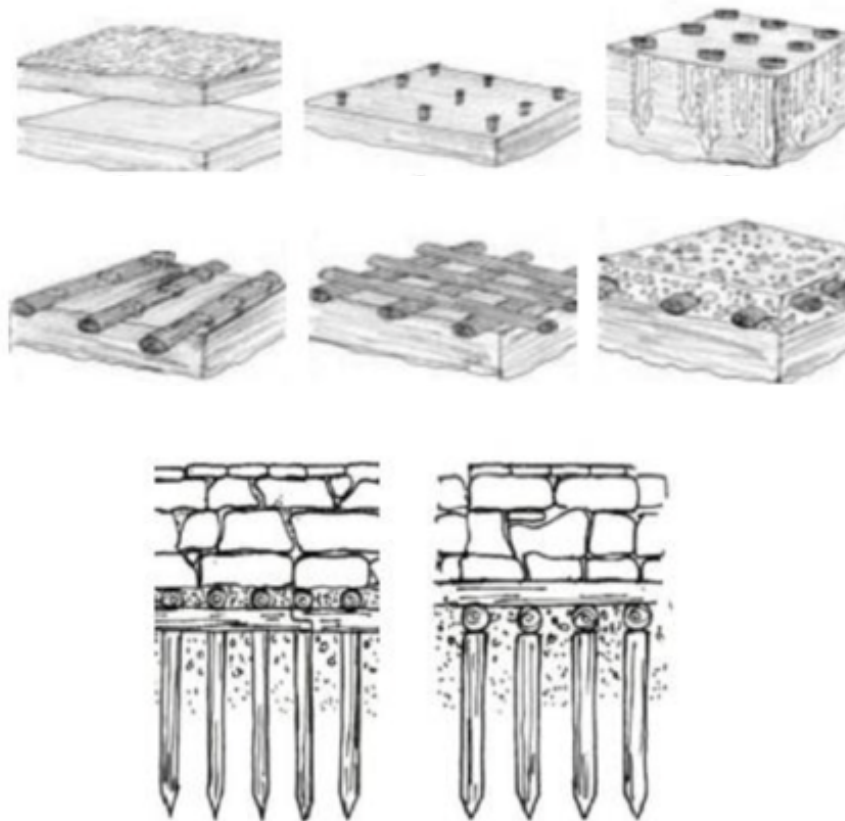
Esquema de fundações indiretas | Estacaria em madeira
